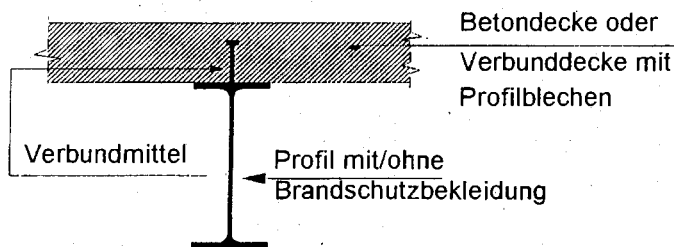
Verbundträger mit Stahlträgern ohne Kammerbeton
